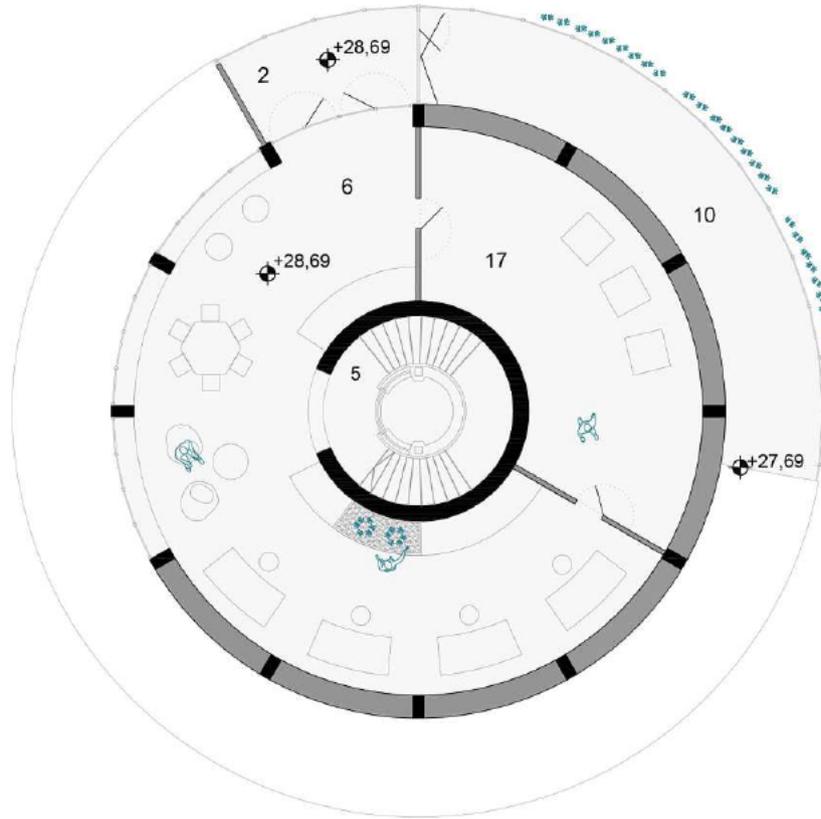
2.6 Grundriss 5.Obergeschoss
